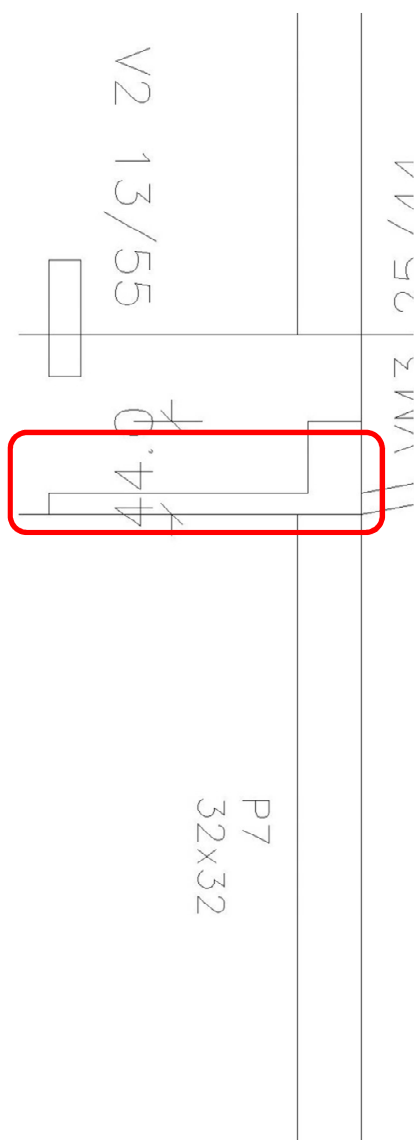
Corte BB, fachada oeste da edificação, em destaque a laje não executada durante a obra.
